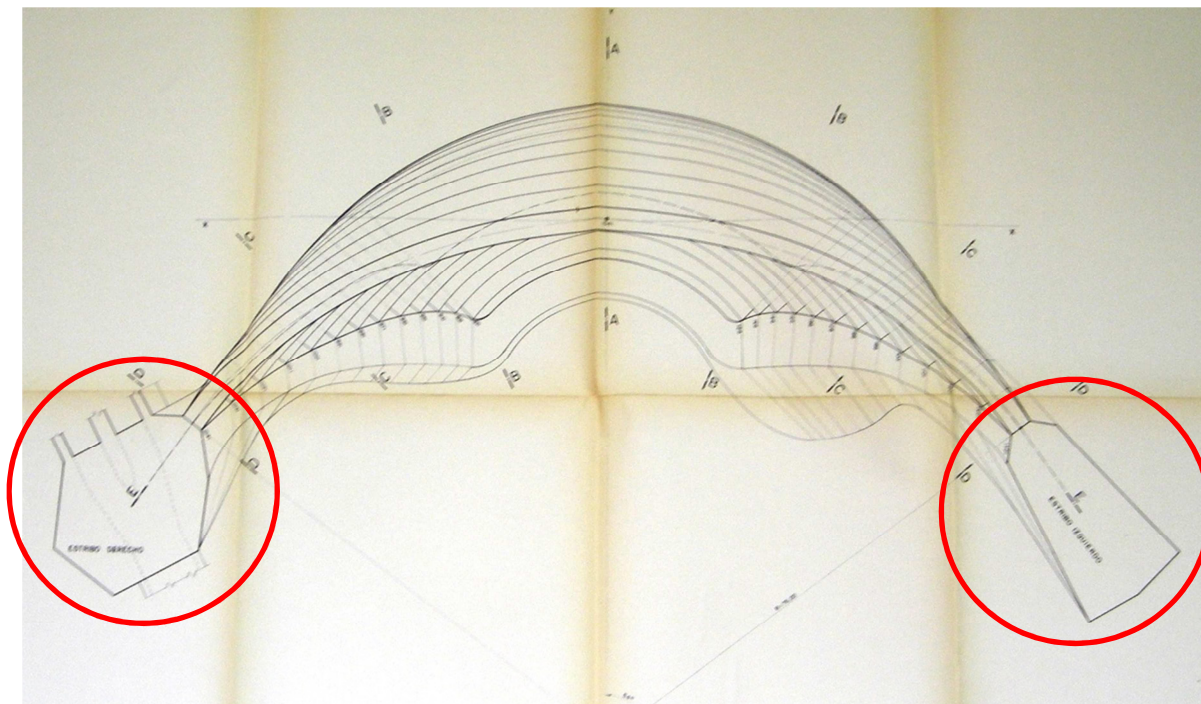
Plano en planta del Proyecto de la presa de Quéntar. En rojo los estribos de gravedad.
